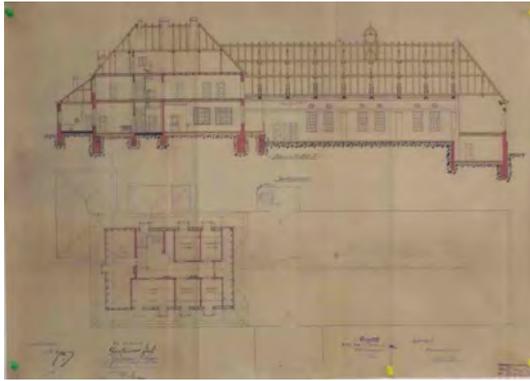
Grundriss Dachgeschoss + Längsschnitt
